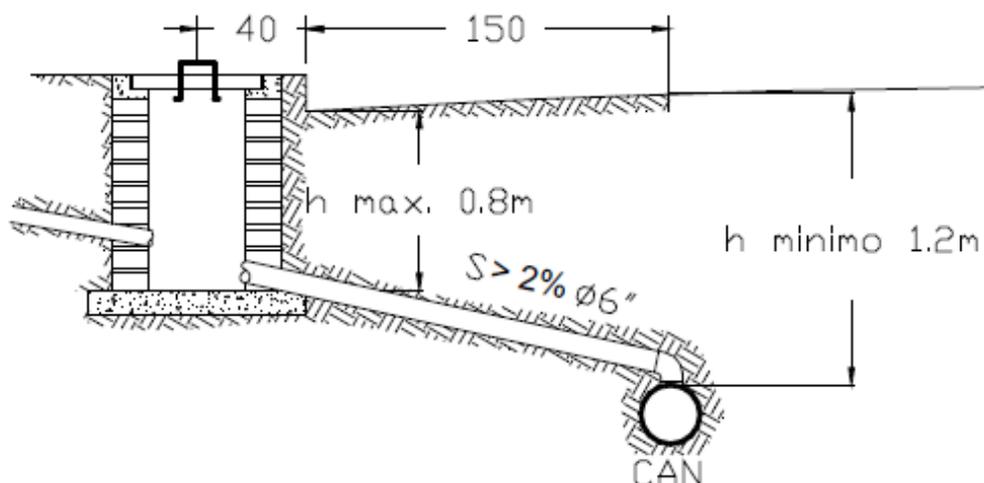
2 Acometida de aguas negras con caja de mampostería de ladrillo de barro.
